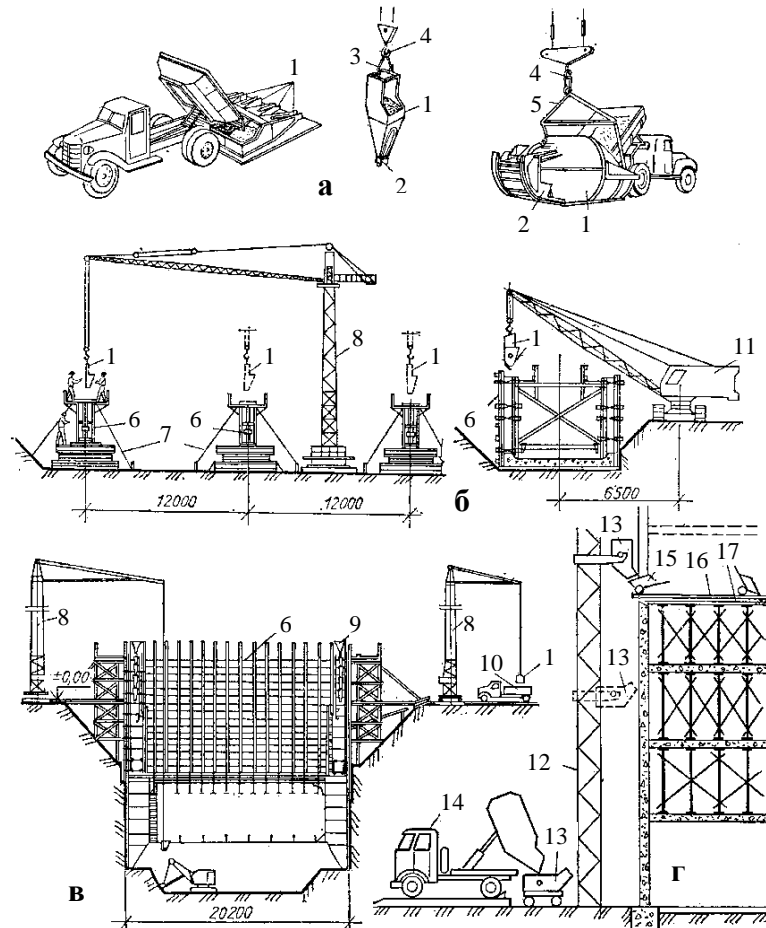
Схеми подавання бетонної суміші кранами і підйомниками: а – завантаження цебер; б – бетонування фундаментів у разі розташування крана всередині й на брівці котловану; в – бетонування стінок опускного колодезя; г – використання підйомника для подавання бетонної суміші; 1 – цебер; 2 – затвор; 3, 5 – підвіски; 4 – гак крана; 6 – опалубка; 7 – розпірки; 8 – крани; 9 – воронка ланкового хобота; 10 – автобетоновіз; 11 – гусеничний кран; 12 – підйомник; 13 – роздавальний бункер; 14 – самоскид; 15 – тачка; 16 – качальні ходи; 17 – бетоновані перекриття
